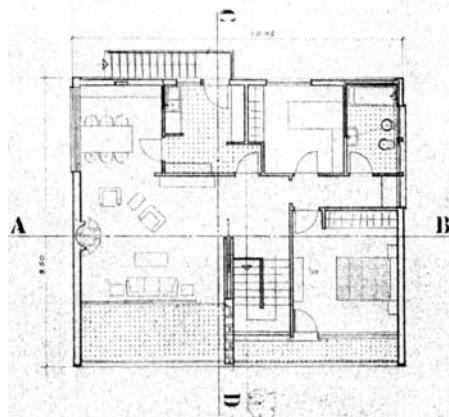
Casa Joaquim Byrne, António Baroseiro, 1957. Planta piso 1.
